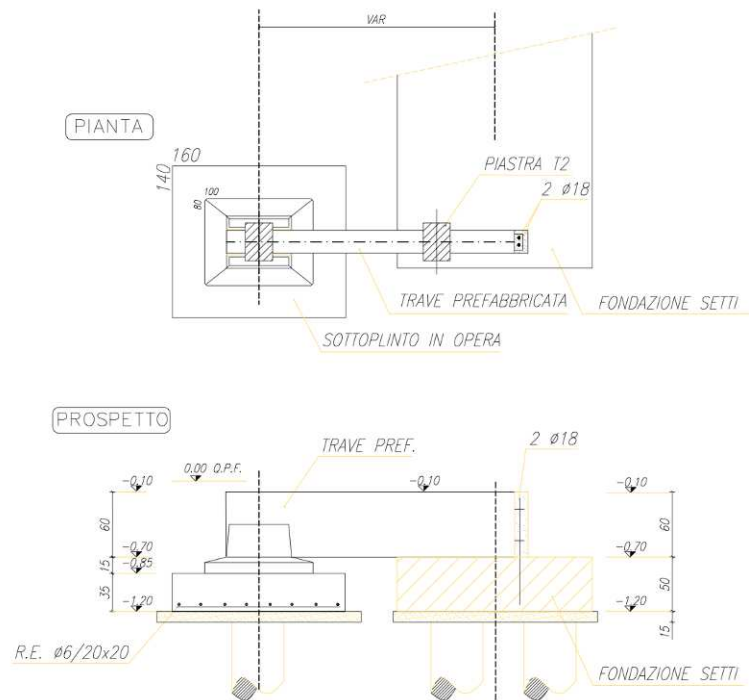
Sistema di collegamento orizzontale in fondazione per edifici industriali
